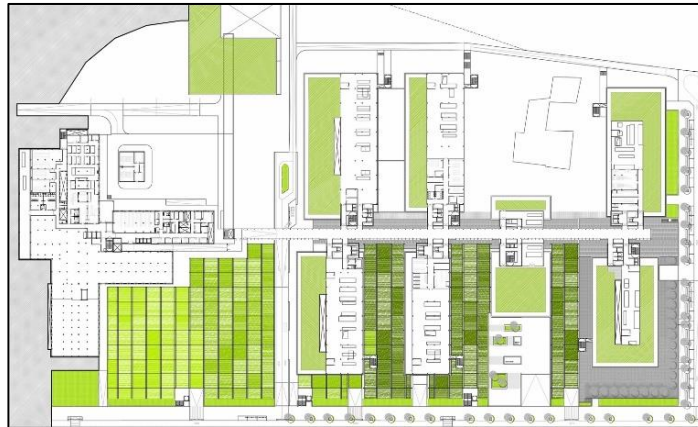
Planta Baja, Hospital Can Misses, España.
